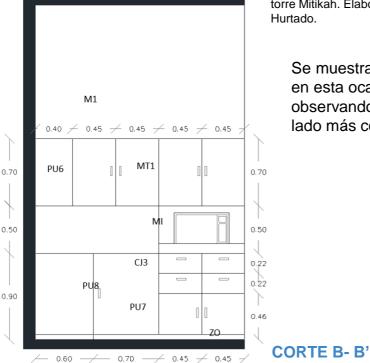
Diseño en alzado de cocina departamento torre Mitikah. Elaboración conjunta, Álvarez, González, Hurtado.
